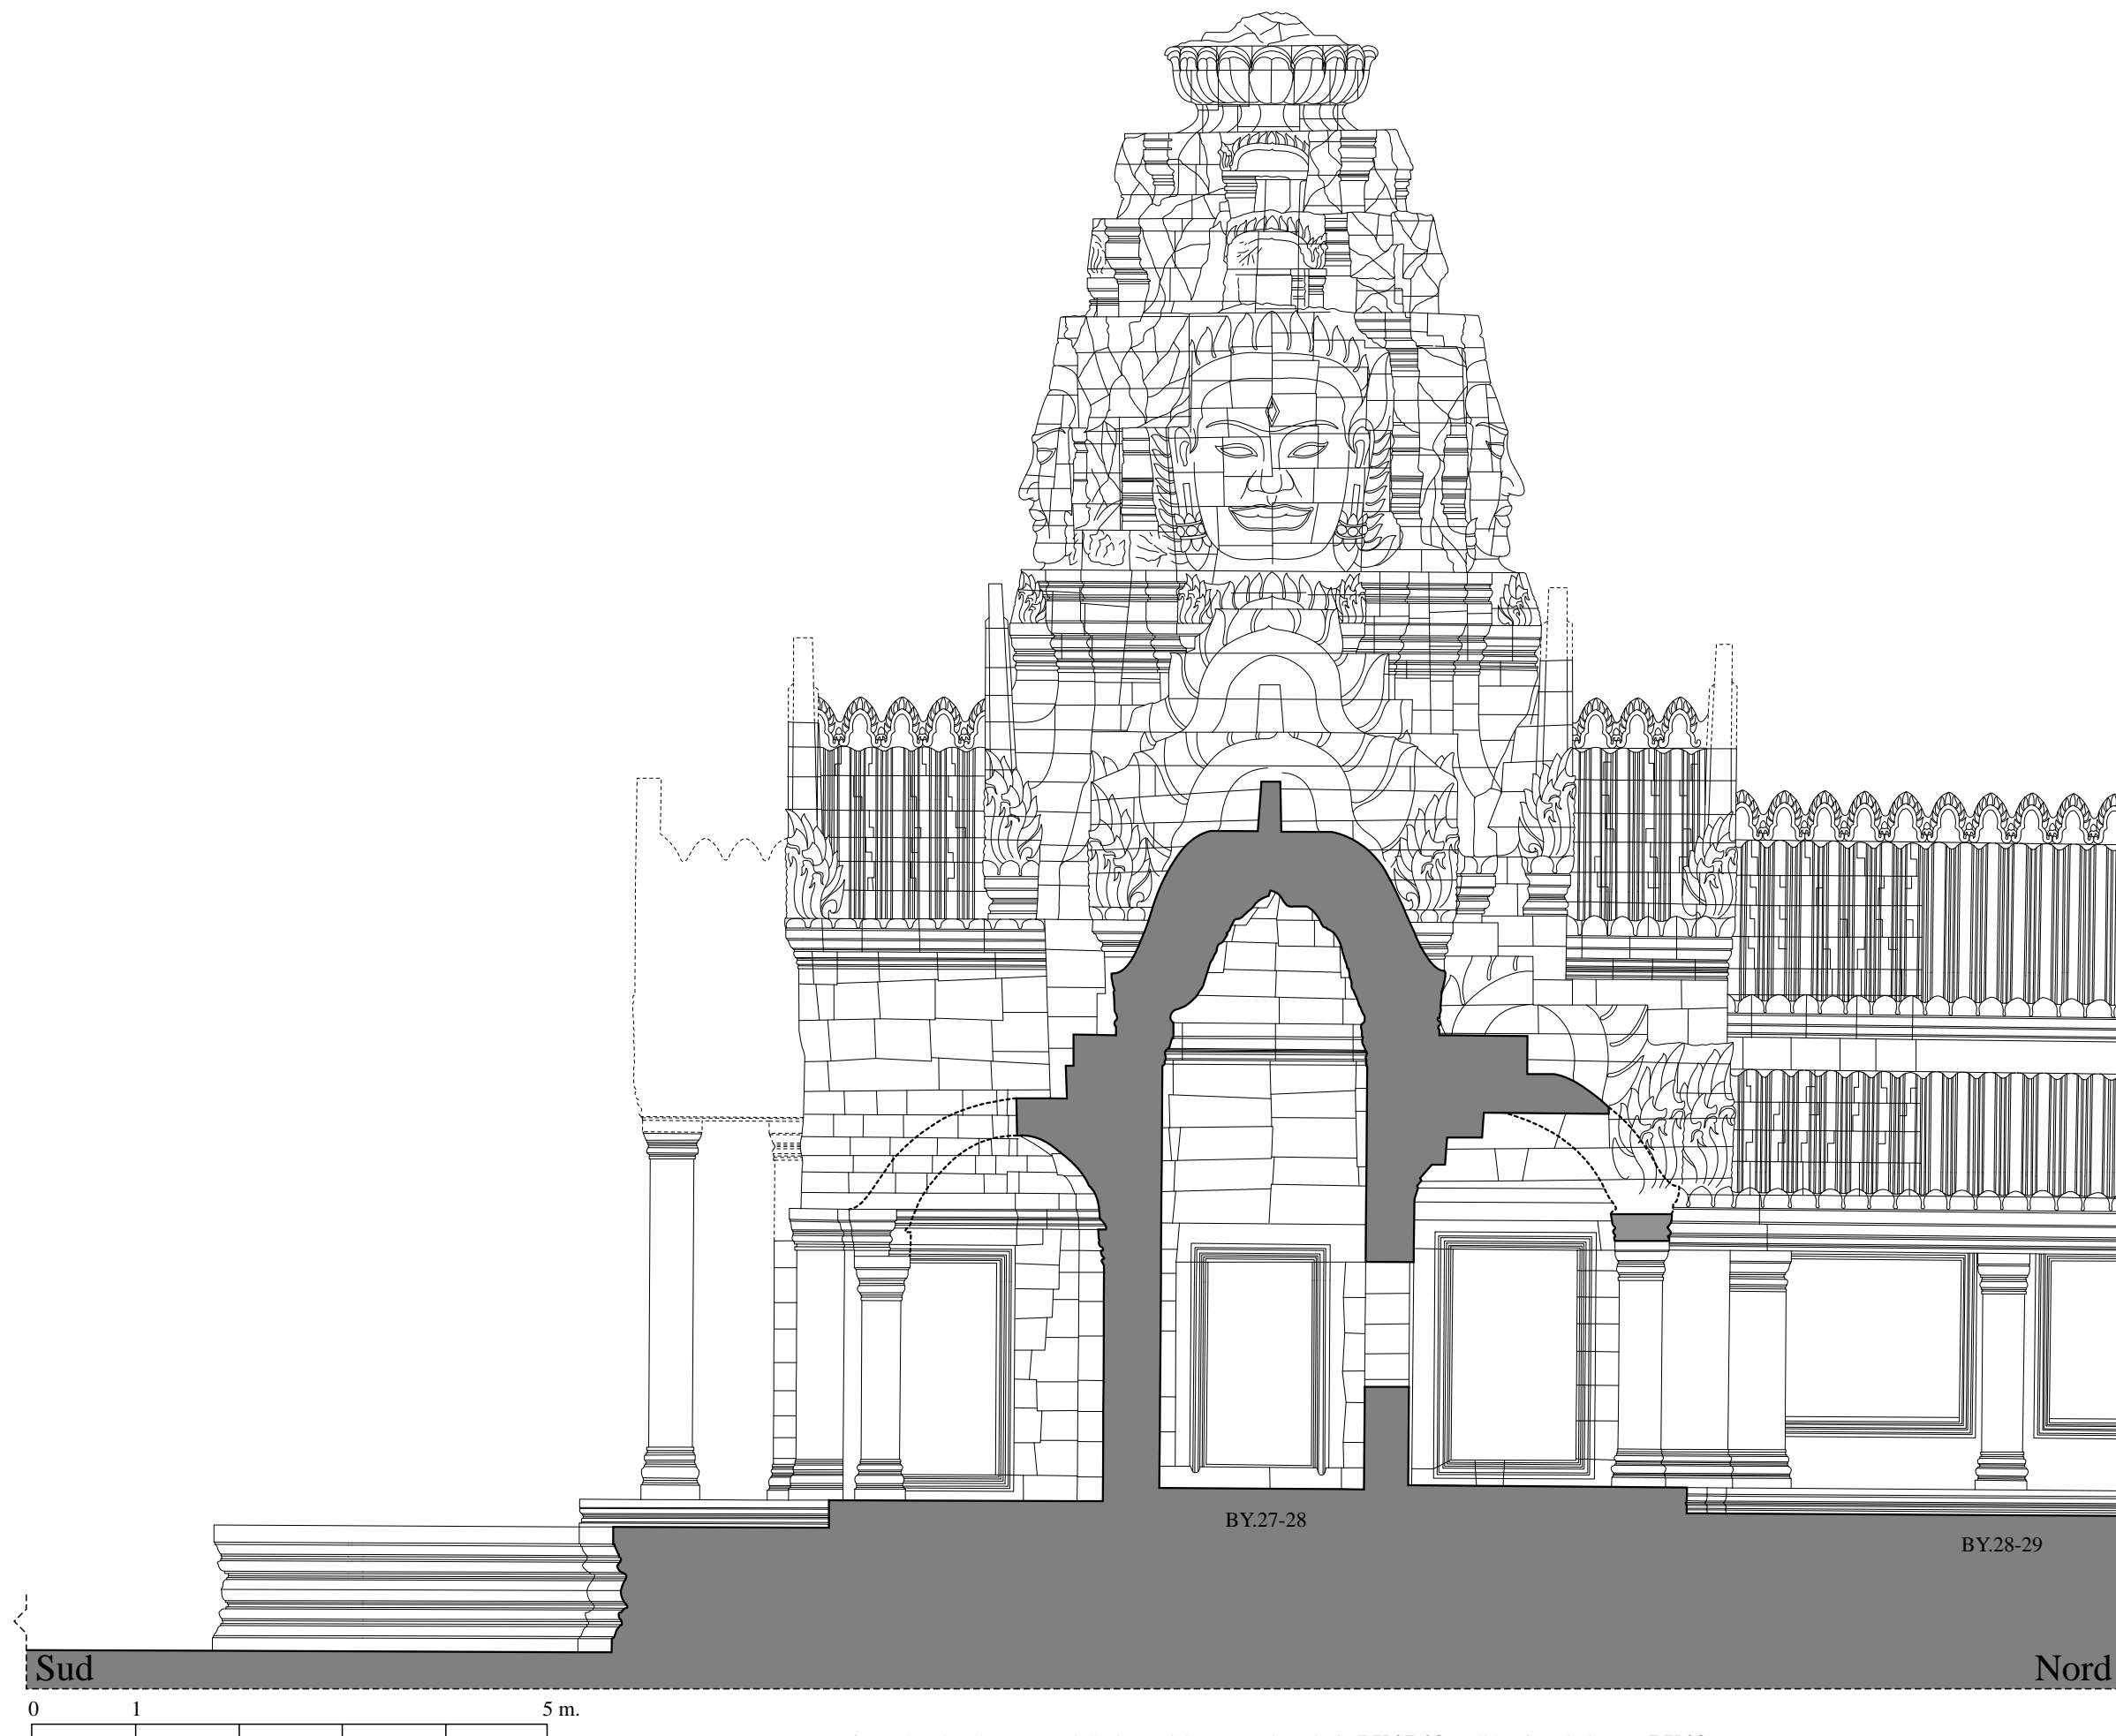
Coupe Nord-Sud vers l'Ouest sur la galerie BY.27-28 et élévation de la tour BY.28
